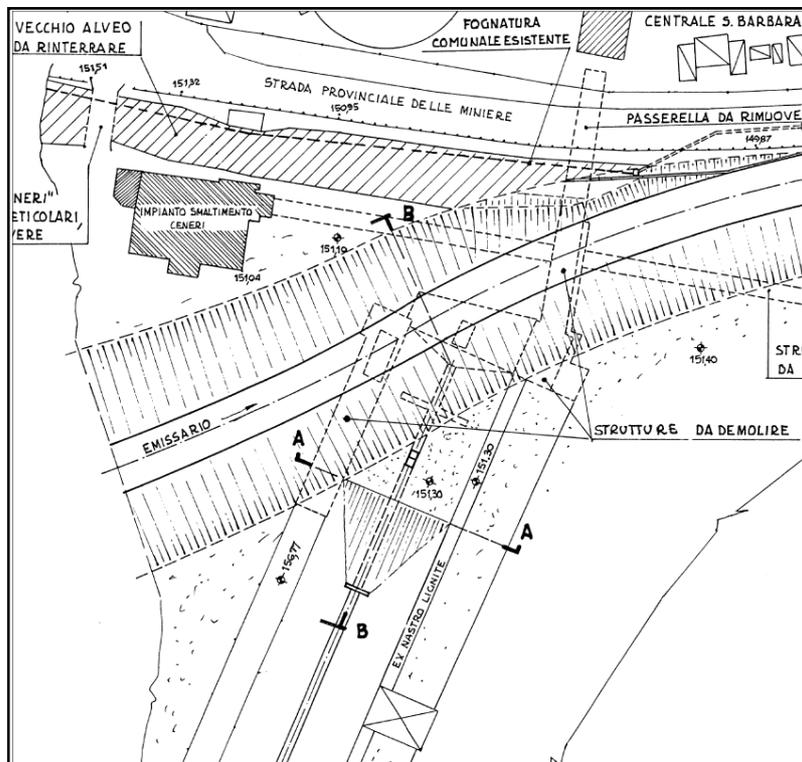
PLANIMETRIA EMISSARIO ZONA BUNKER: PROGETTO DEFINITIVO (PART. TAV. 748)
